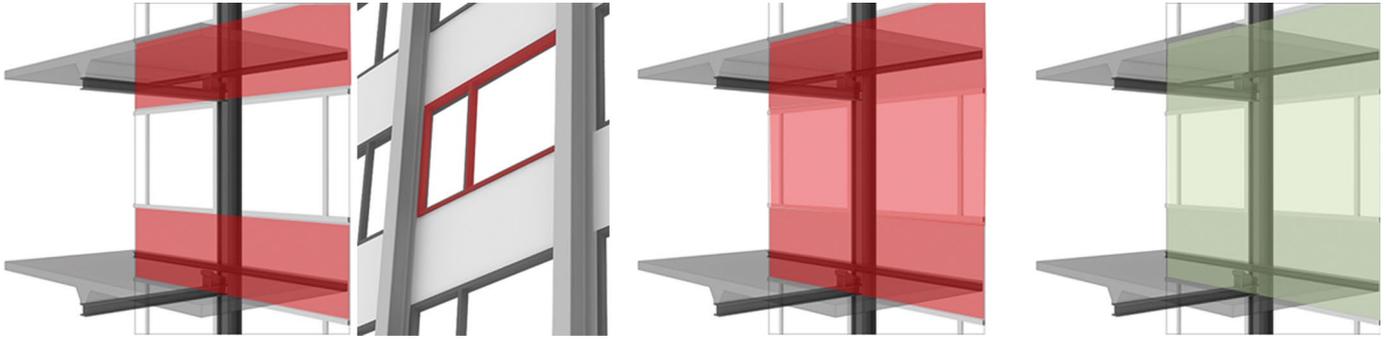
Varianten zur energetischen Aufrüstung: a) Innendämmung Brüstung, b) Außendämmung Rahmen, c) Innendämmung Brüstung und zweites Fensterelement, d) Rekonstruktion der Fassade
